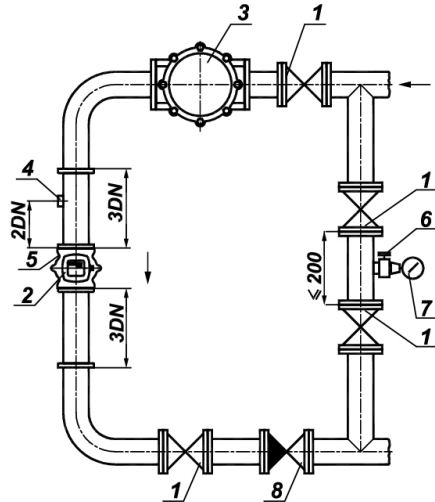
Схема монтажу лічильника (з байпасом) на вертикальному газопроводі
